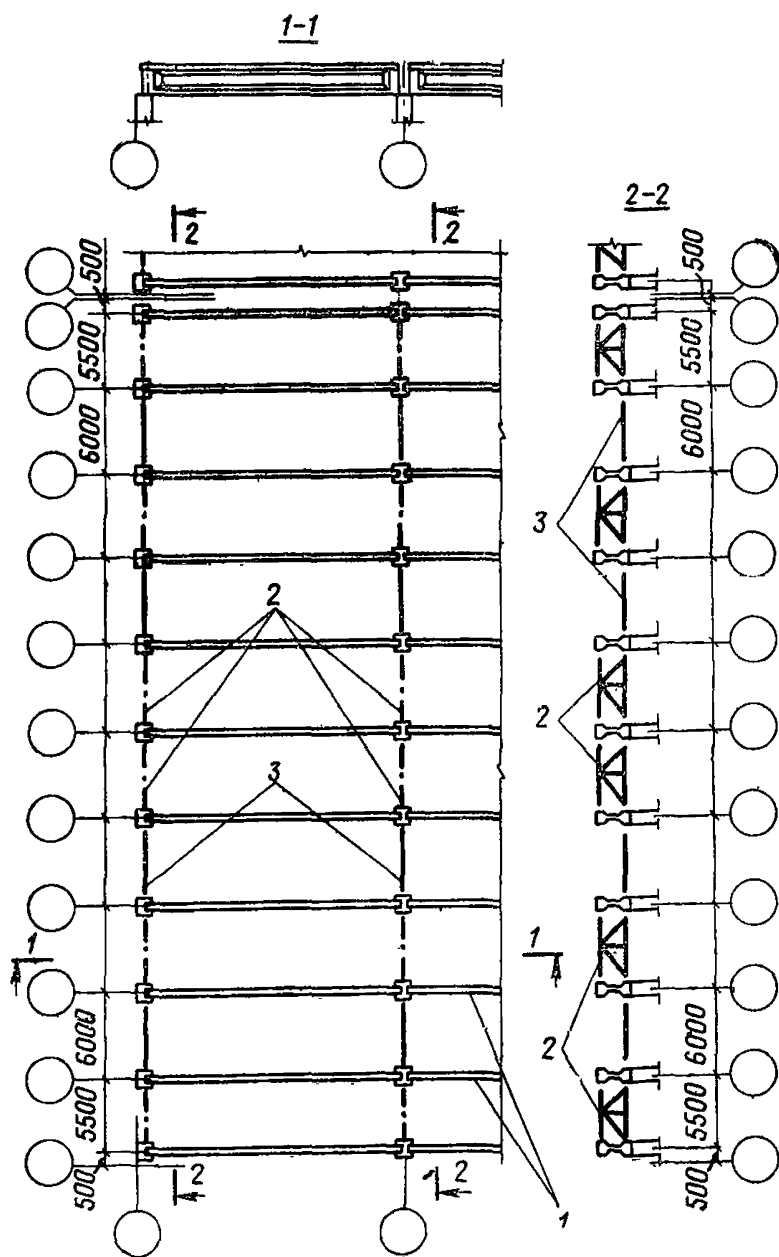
Пример расположения связей покрытия с балками (при плоской кровле) в зданиях с шагом колонн 6 м при расчетной сейсмичности 9 баллов
